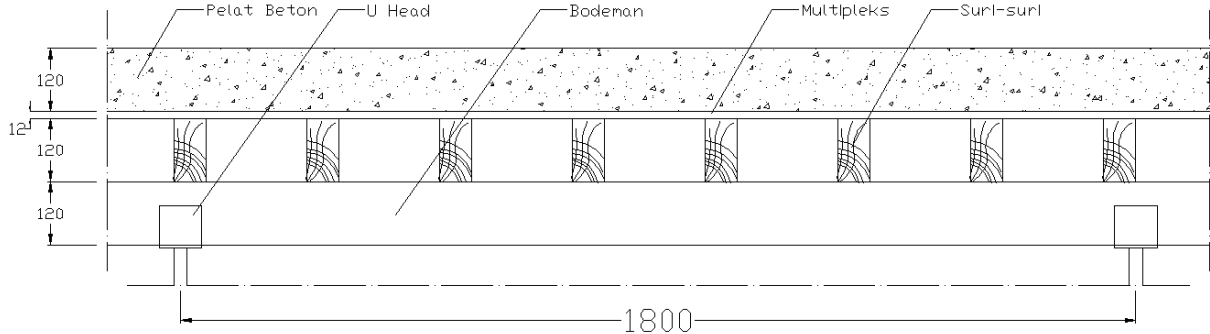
Balok Arah X yang Ditinjau Pada Denah Lantai 2
